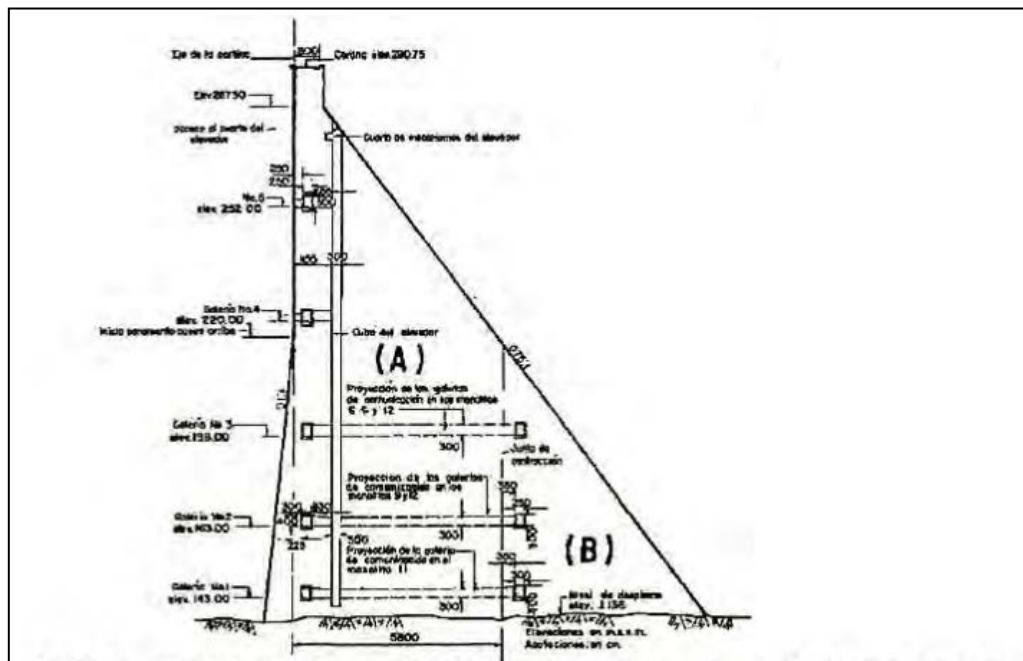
Sección transversal y ubicación de las galerías de la cortina tipo gravedad.
